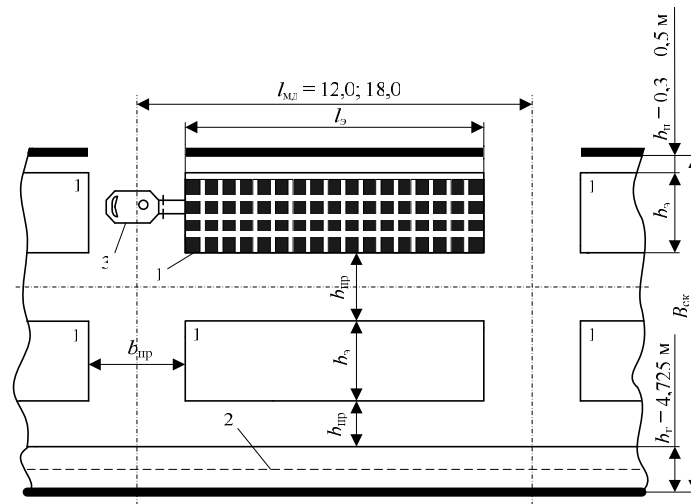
Схема к расчету параметров элементарной площадки:
